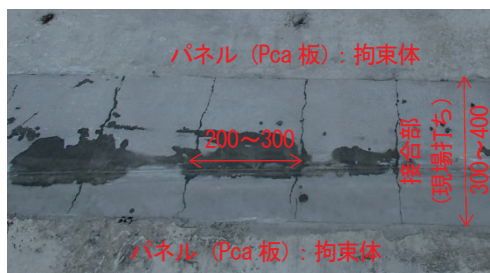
従来工法橋軸方向ひび割れ
